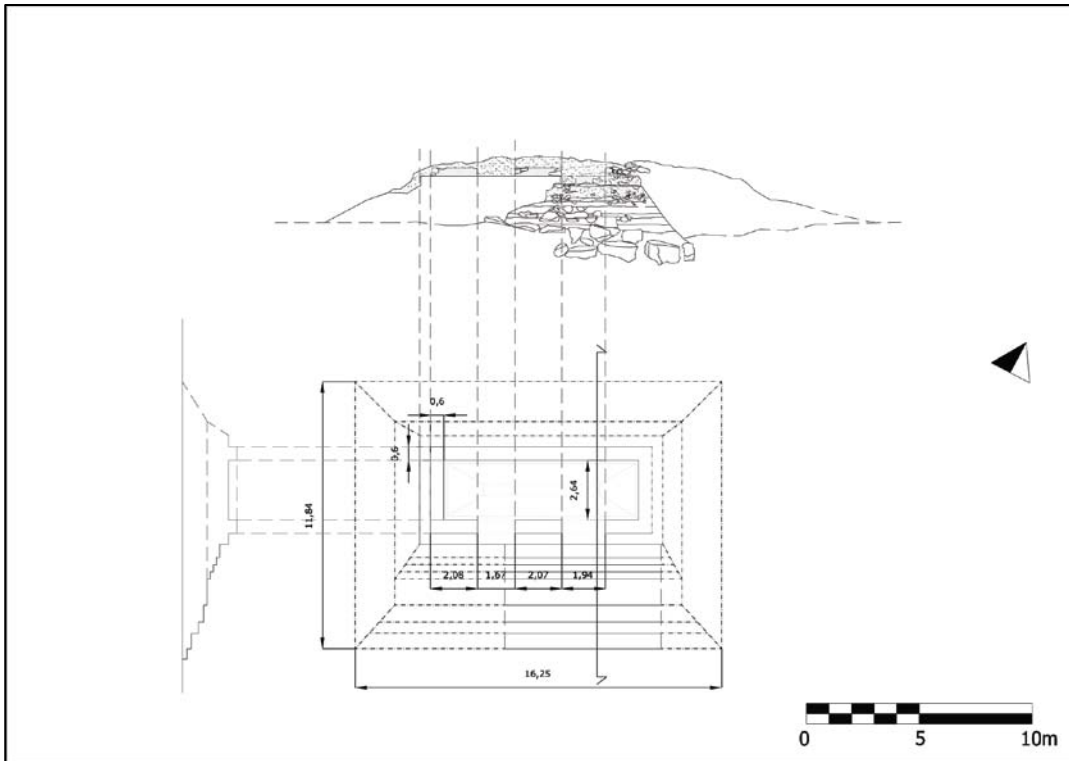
Levantamiento con propuesta reconstructiva de dos accesos. (Elaboración A. Campiani)
